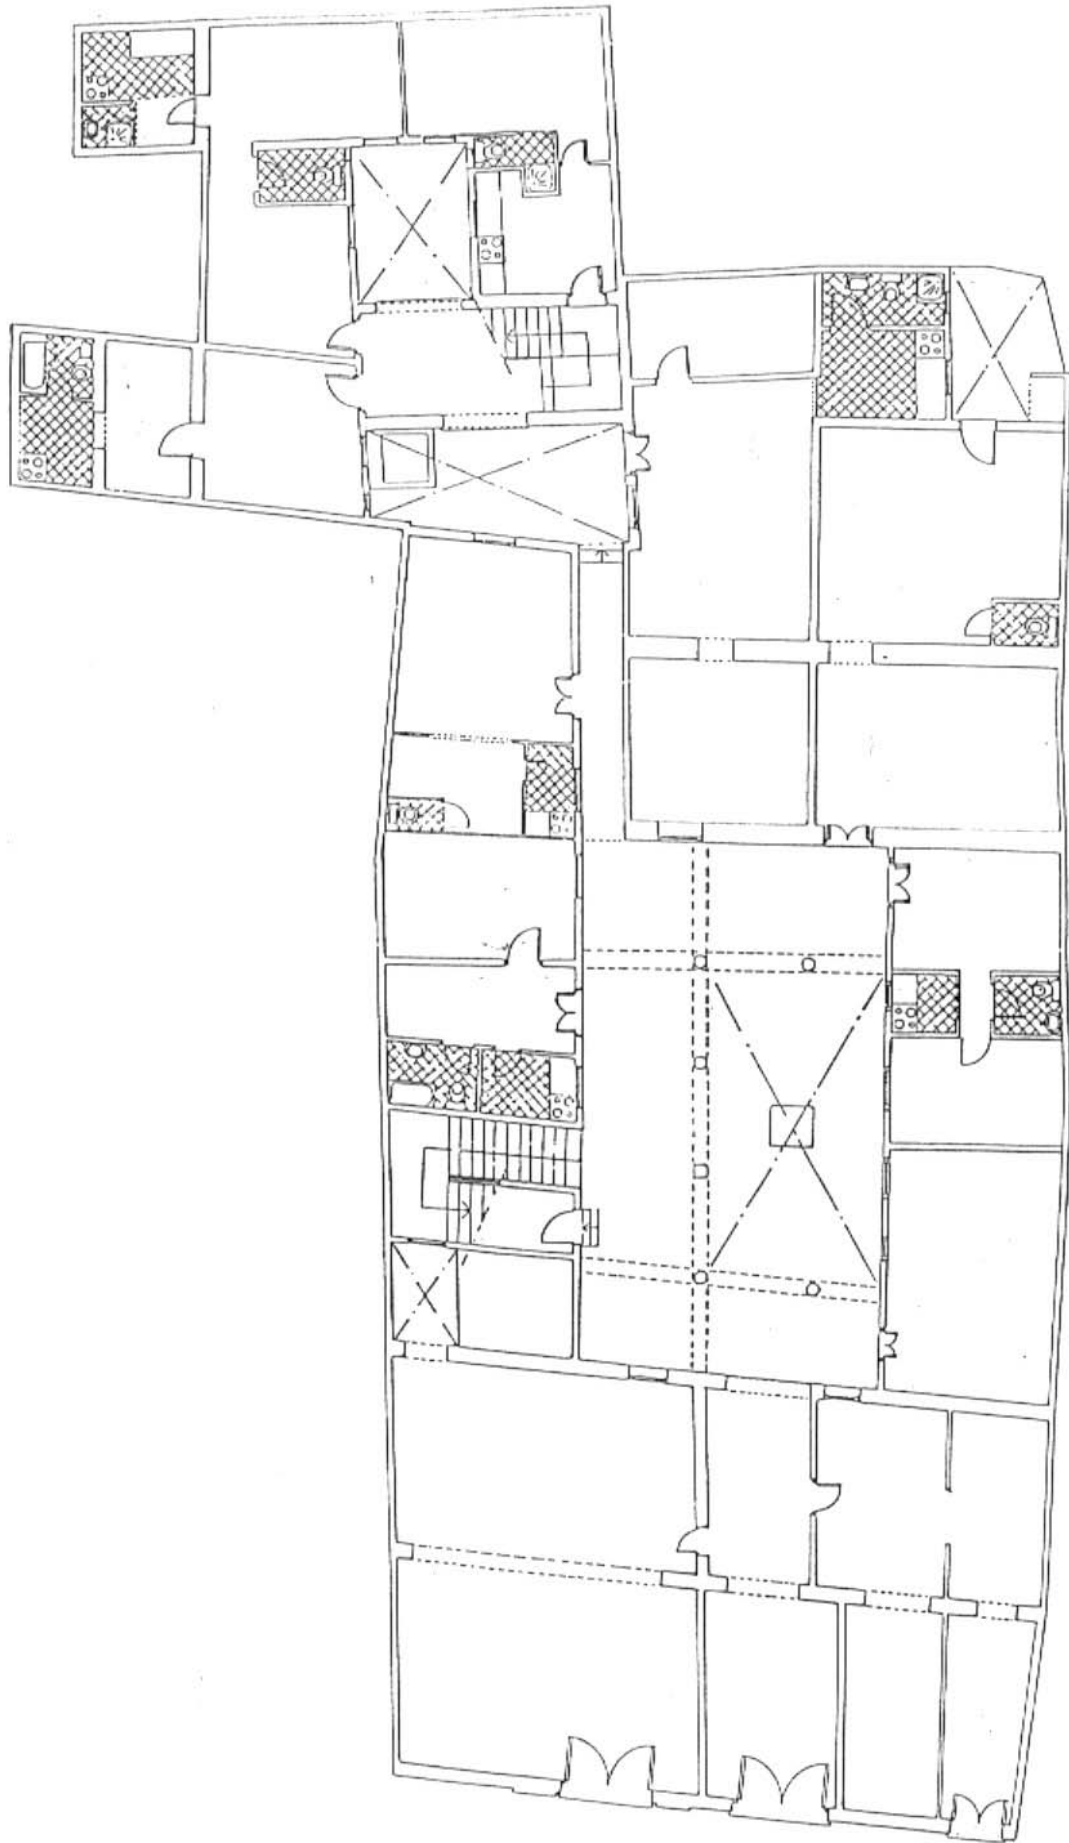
Plano de planta baja de c/ Pureza, 72 en la actualidad.
